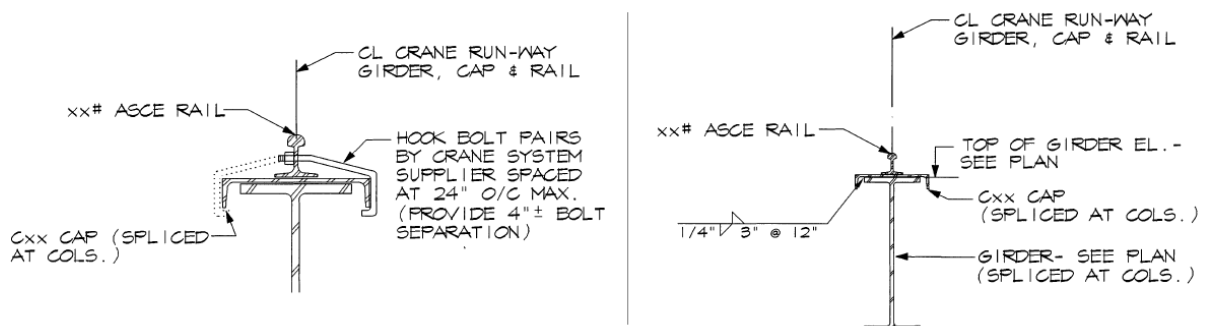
Detalle de la unión Viga carrilera-Puente grúa. Fuente: McGraw-Hill.
